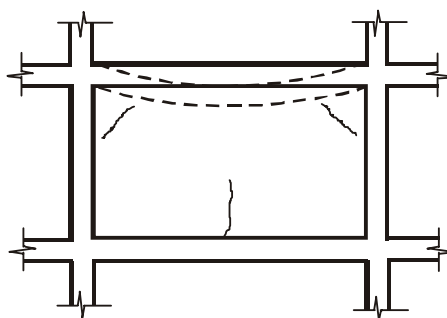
fissuras em parede de vedação por deformação da viga superior (DUARTE, 1998)
